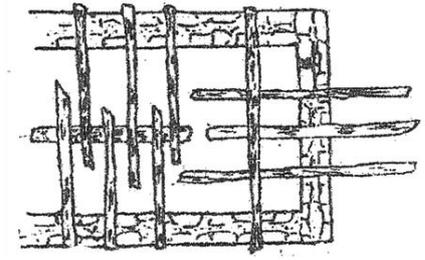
coupe transversale des murs d'une maison au niveau du premier étage
